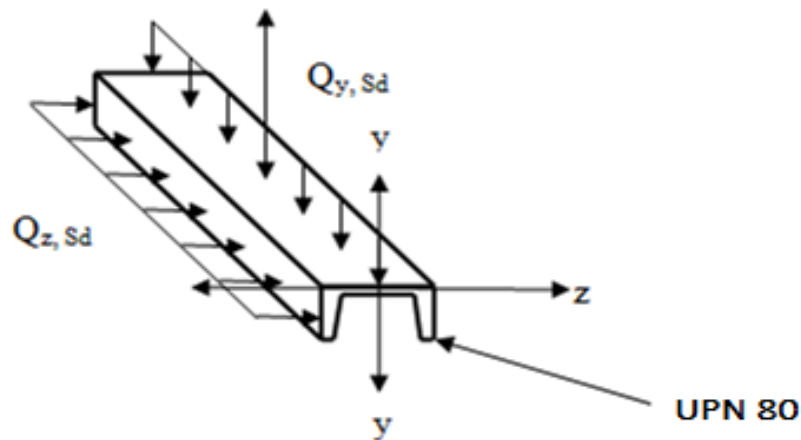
Chargement appliqué au niveau d'une lisse de bardage.
